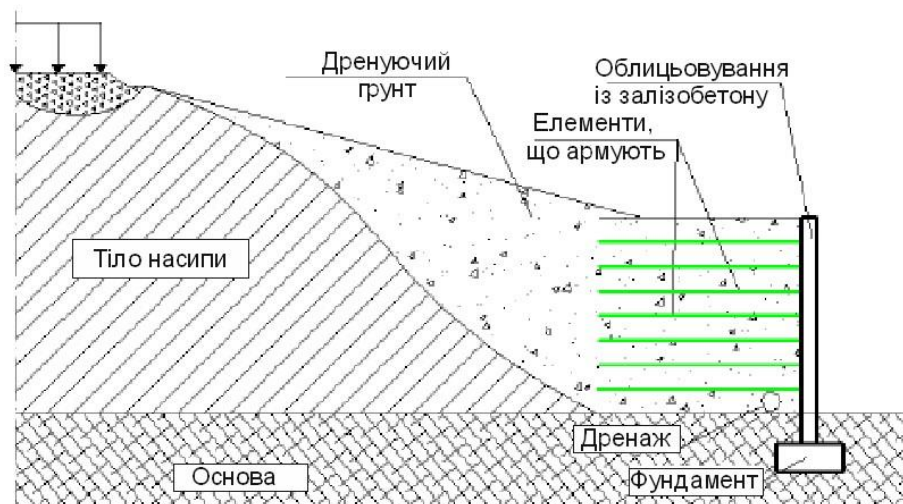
Схема поперечного профілю насипу, посиленого армогрунтовою стіною з облицюванням із суцільної залізобетонної панелі
